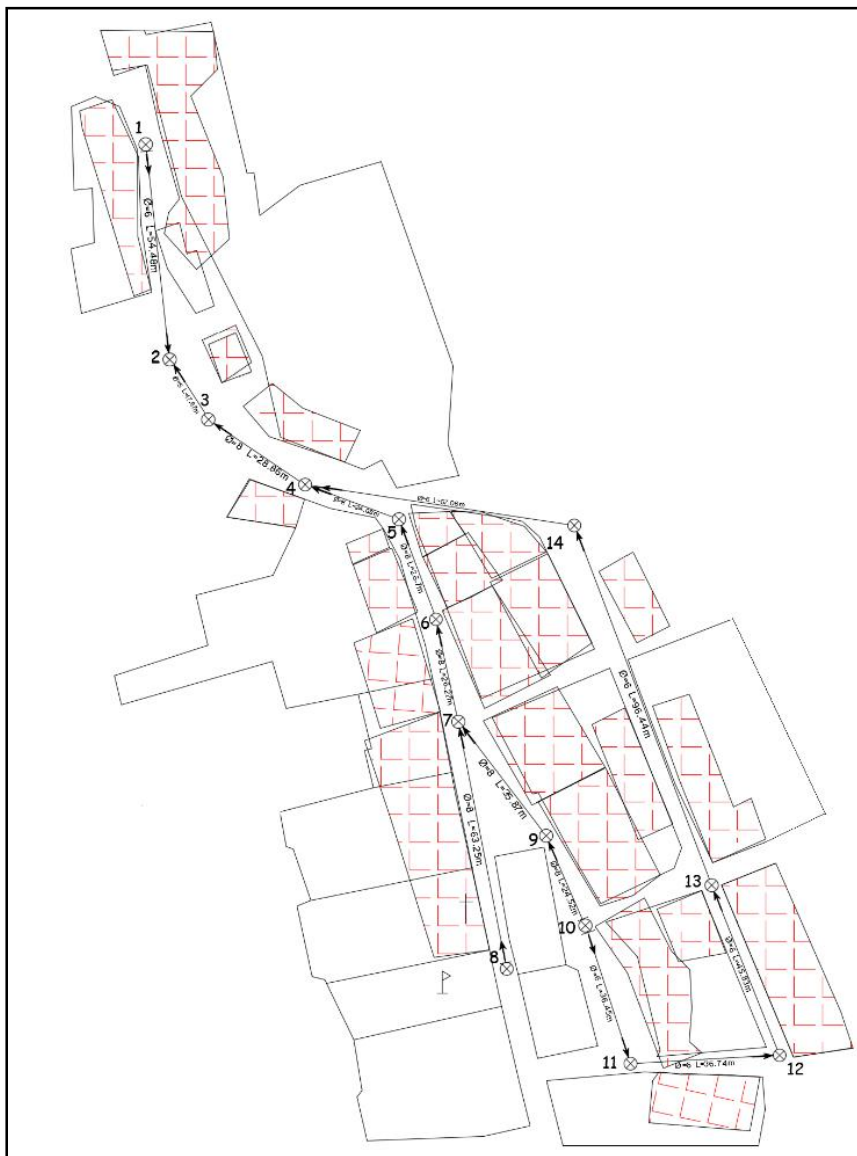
Plano en planta con áreas de contribuciones domesticas alcantarillado viejo.
